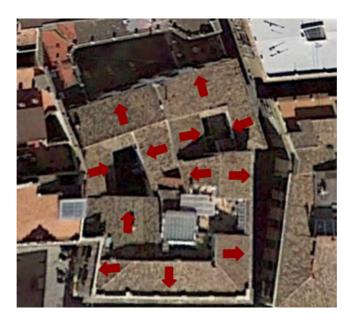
Cubiertas del edificio. Fuente: Fotos de autor.
